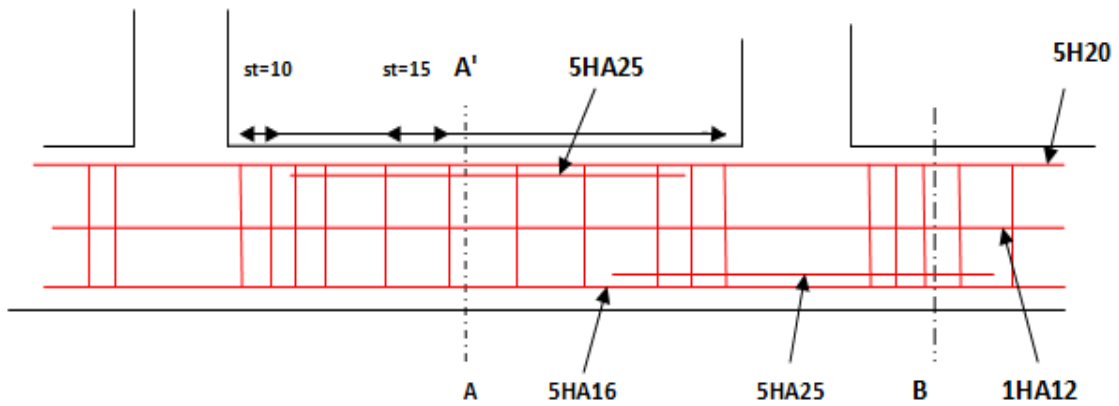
Schéma de ferrailage de la nervure sens x-x.
